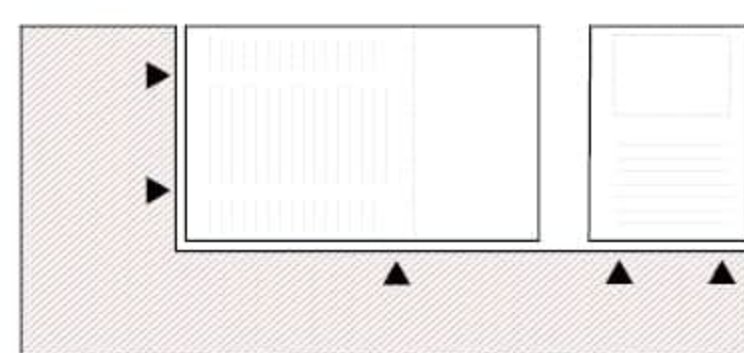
50 Carl Bechstein Haus / Foyer Konzertsaal
